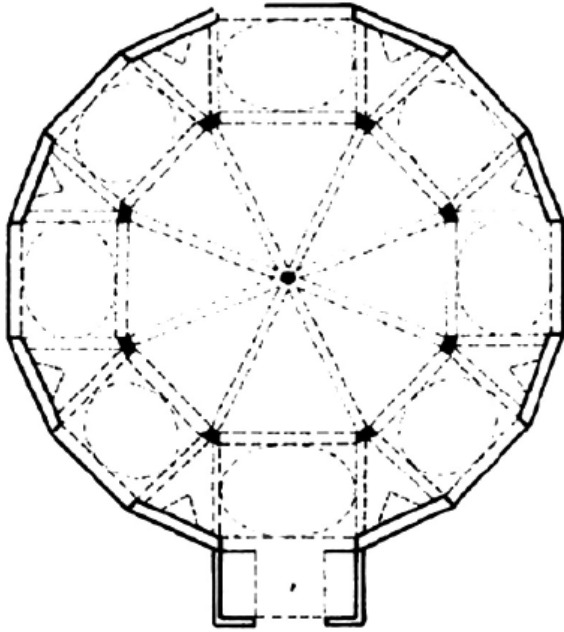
Hinojosa de Jarque (Teruel). Ermita del Pilar. Planta. Autor: Santiago Sebastián.
